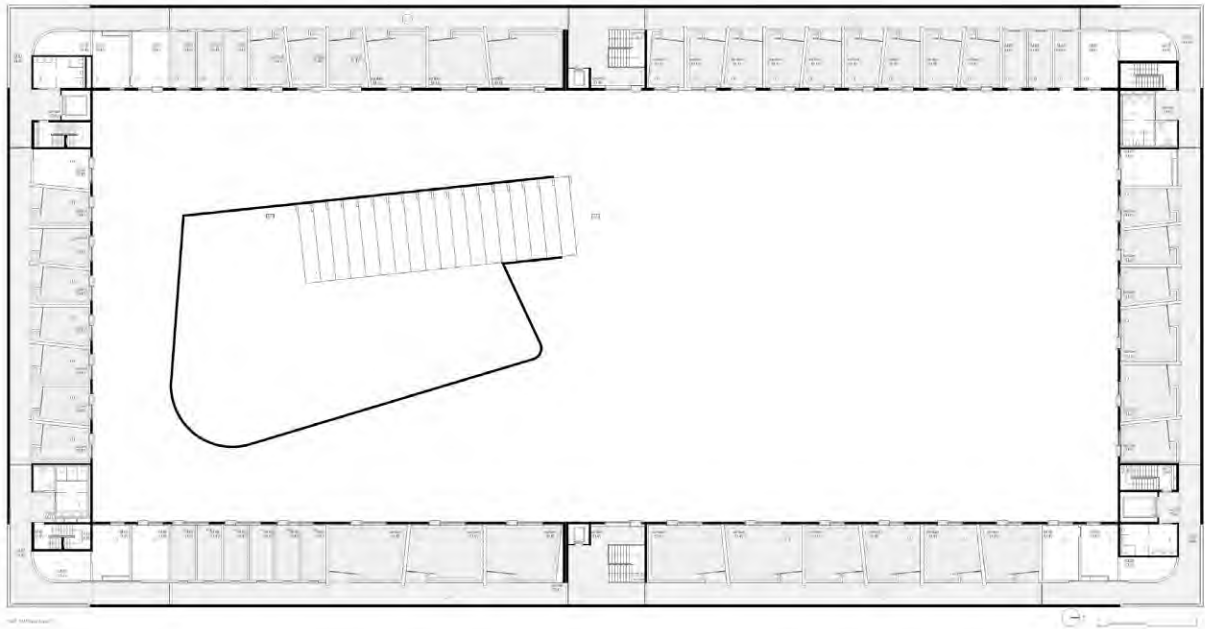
Escola de música de Lisboa - Planta Alta. Fuente: João Luís Carrilho da Graça (2008).
